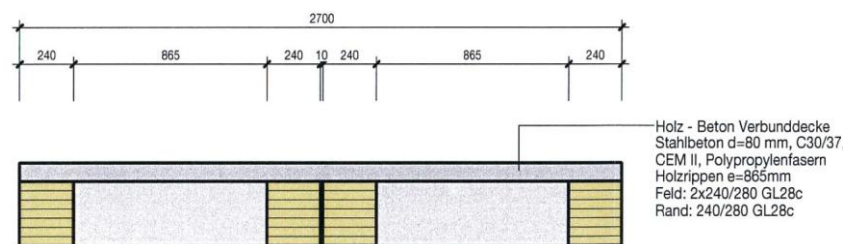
Querschnitt Elementdecke LCT ONE [mkp]
